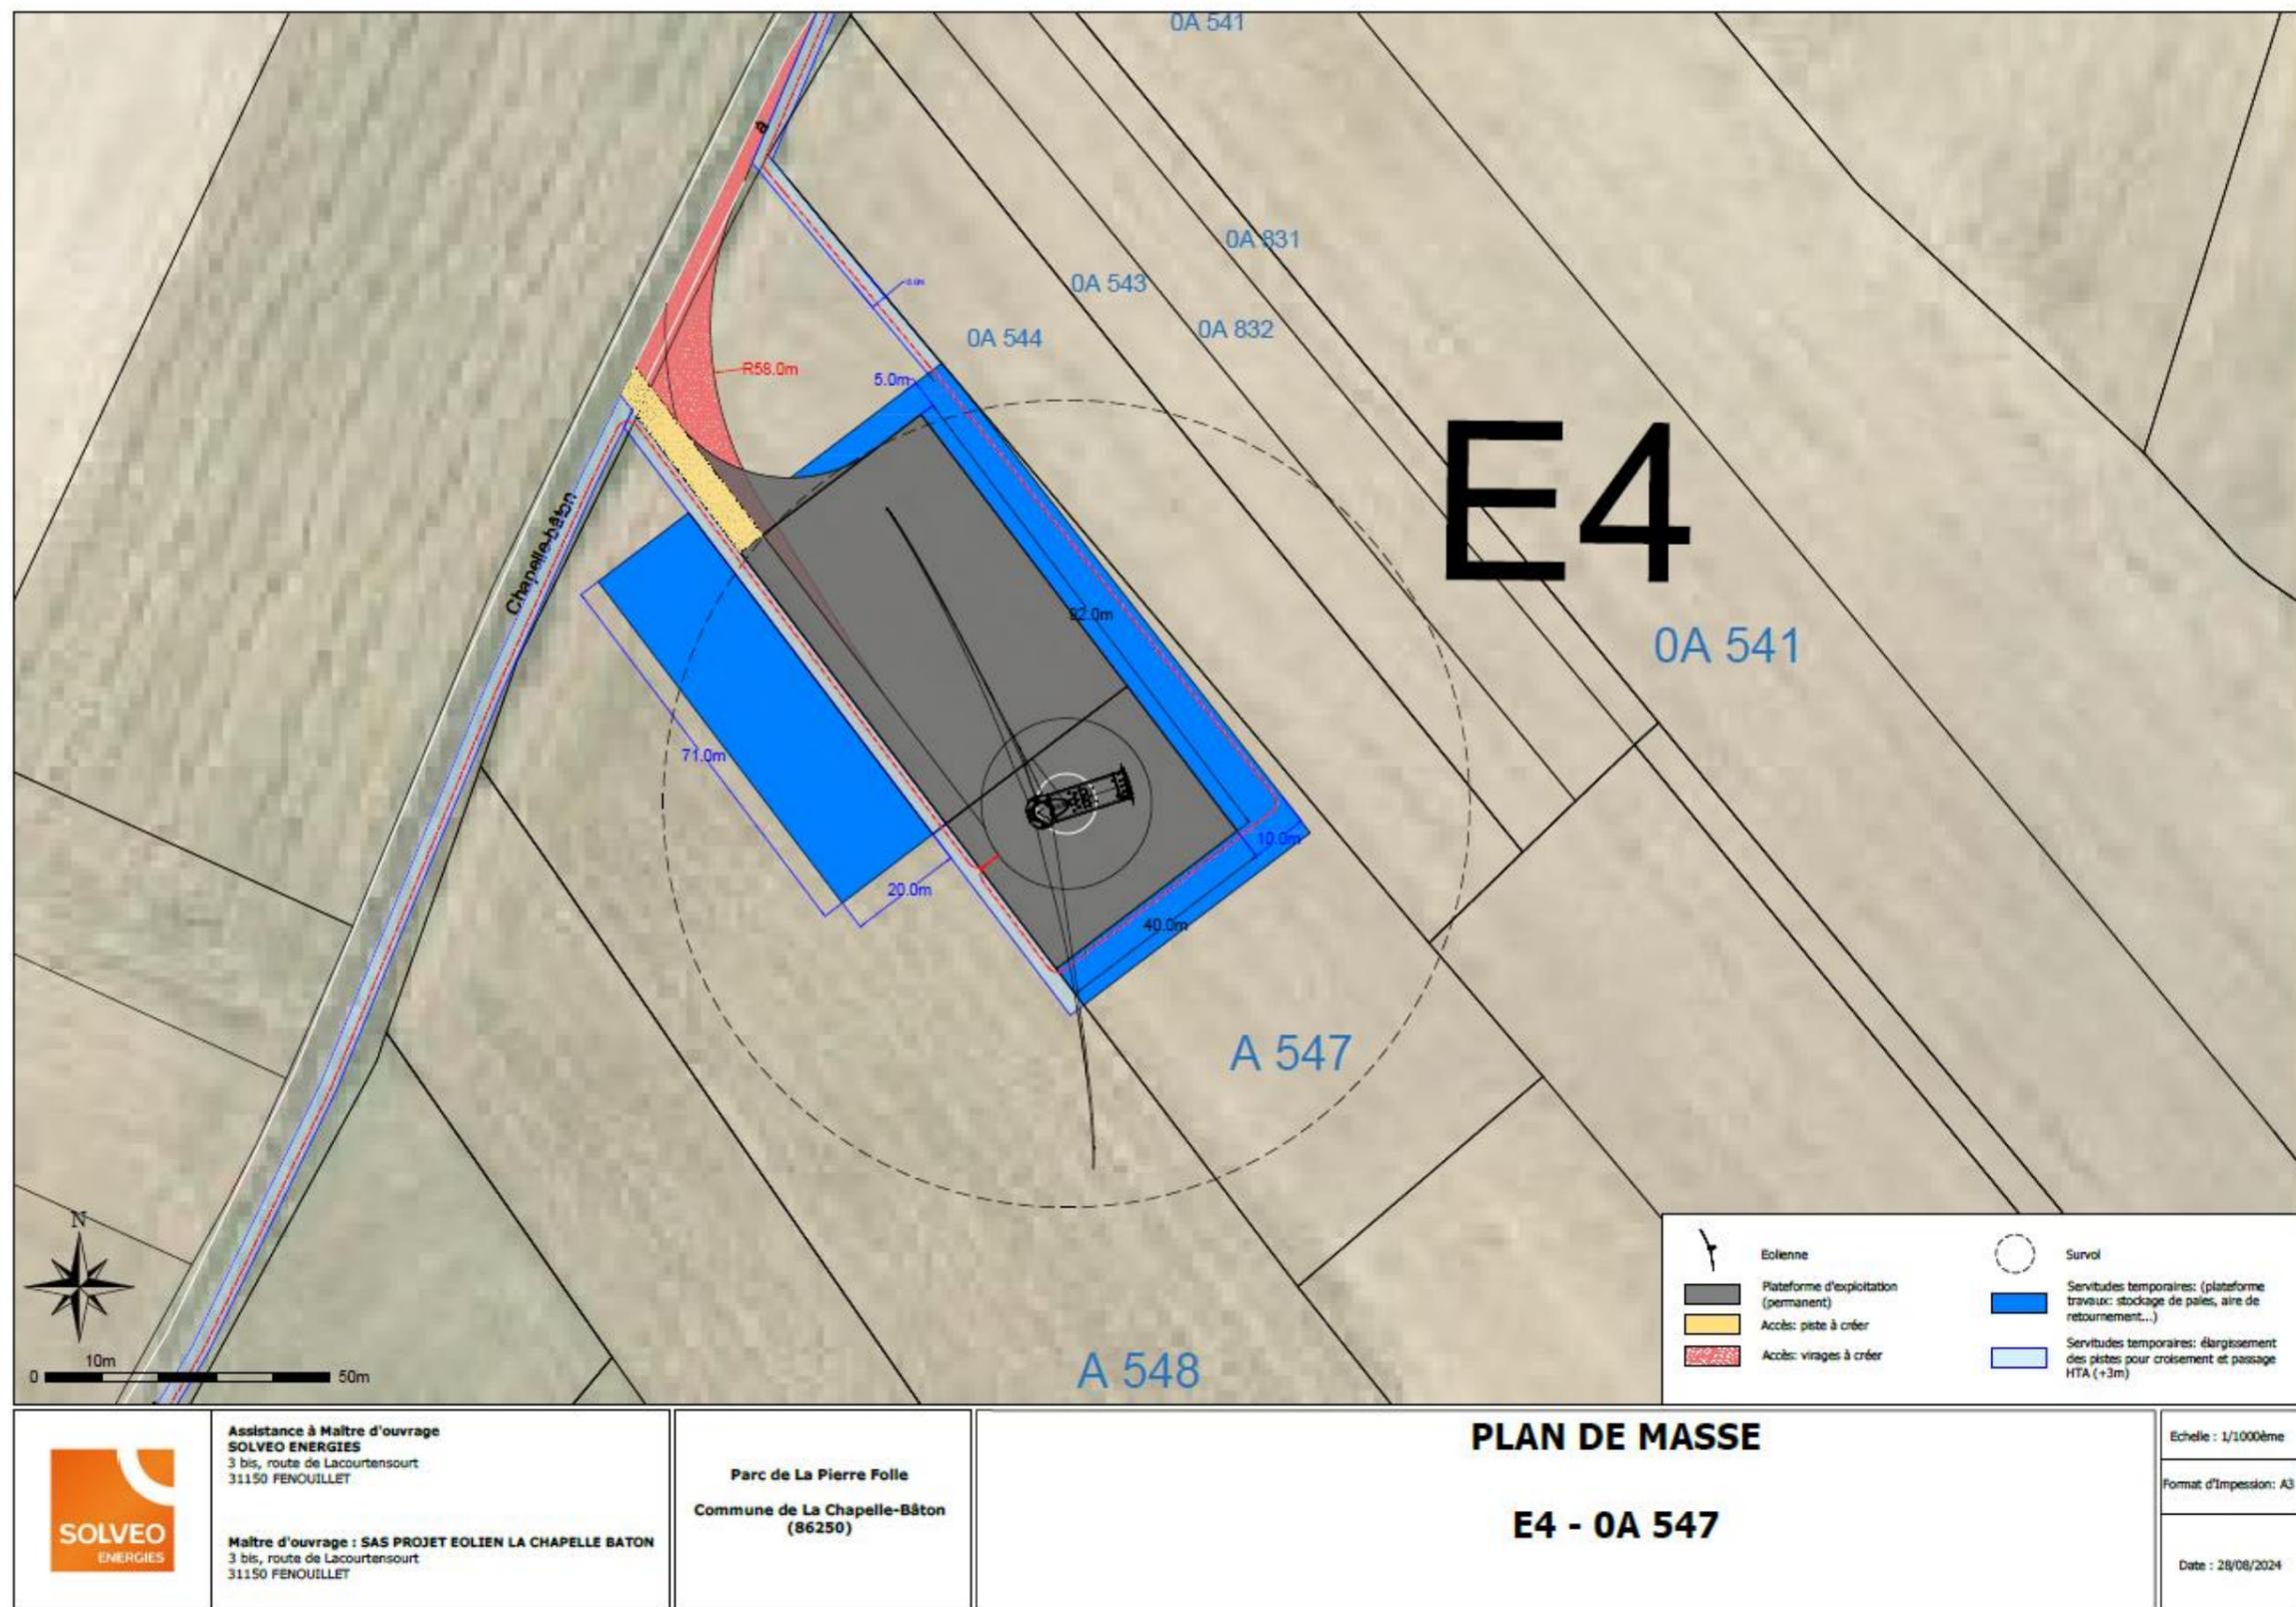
Plan de masse - zoom sur l'éolienne E4
